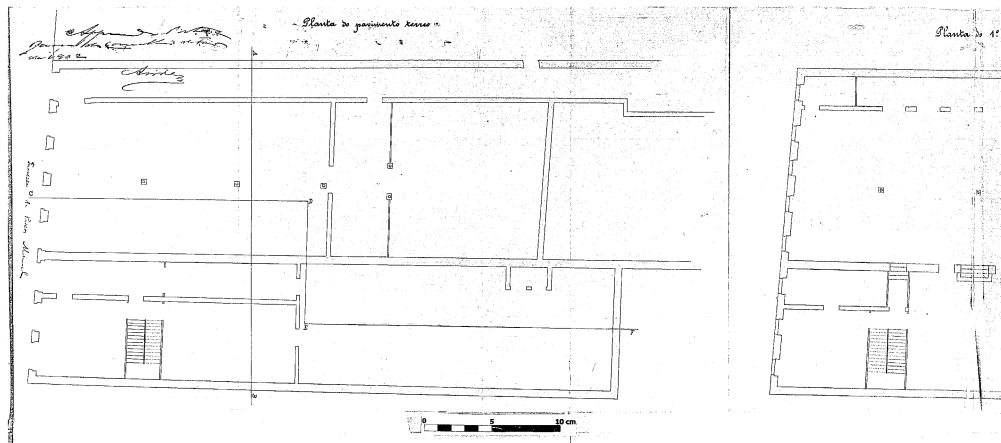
Planta do pavimento térreo da Fábrica Confiança, 1902.⁵⁰
